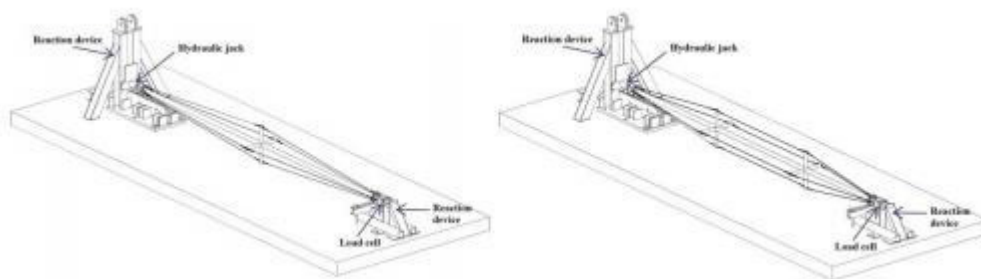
Layout do ensaio das colunas (retirado de D4.1.1 – *HILONG*)
